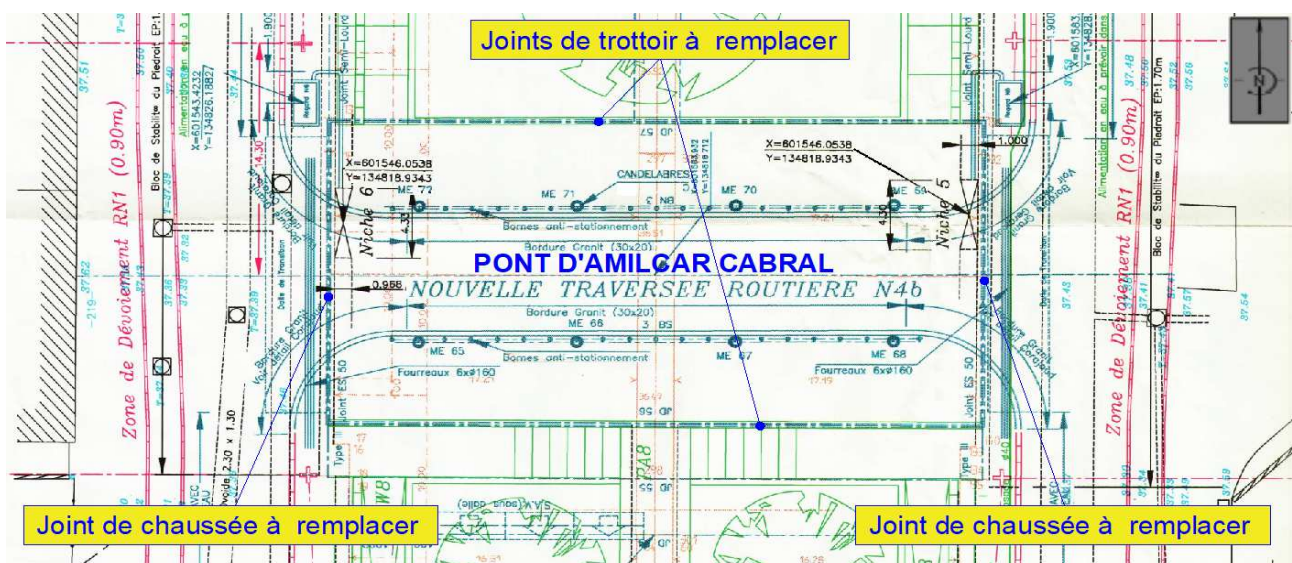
Extrait de la vue en plan des joints de chaussée du Pont de Amilcar Cabral
